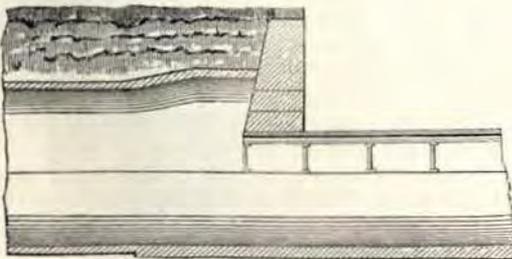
Passaggio di un collettore sotto il canale di Charleroi. Sezione lungo l'asse del collettore.
